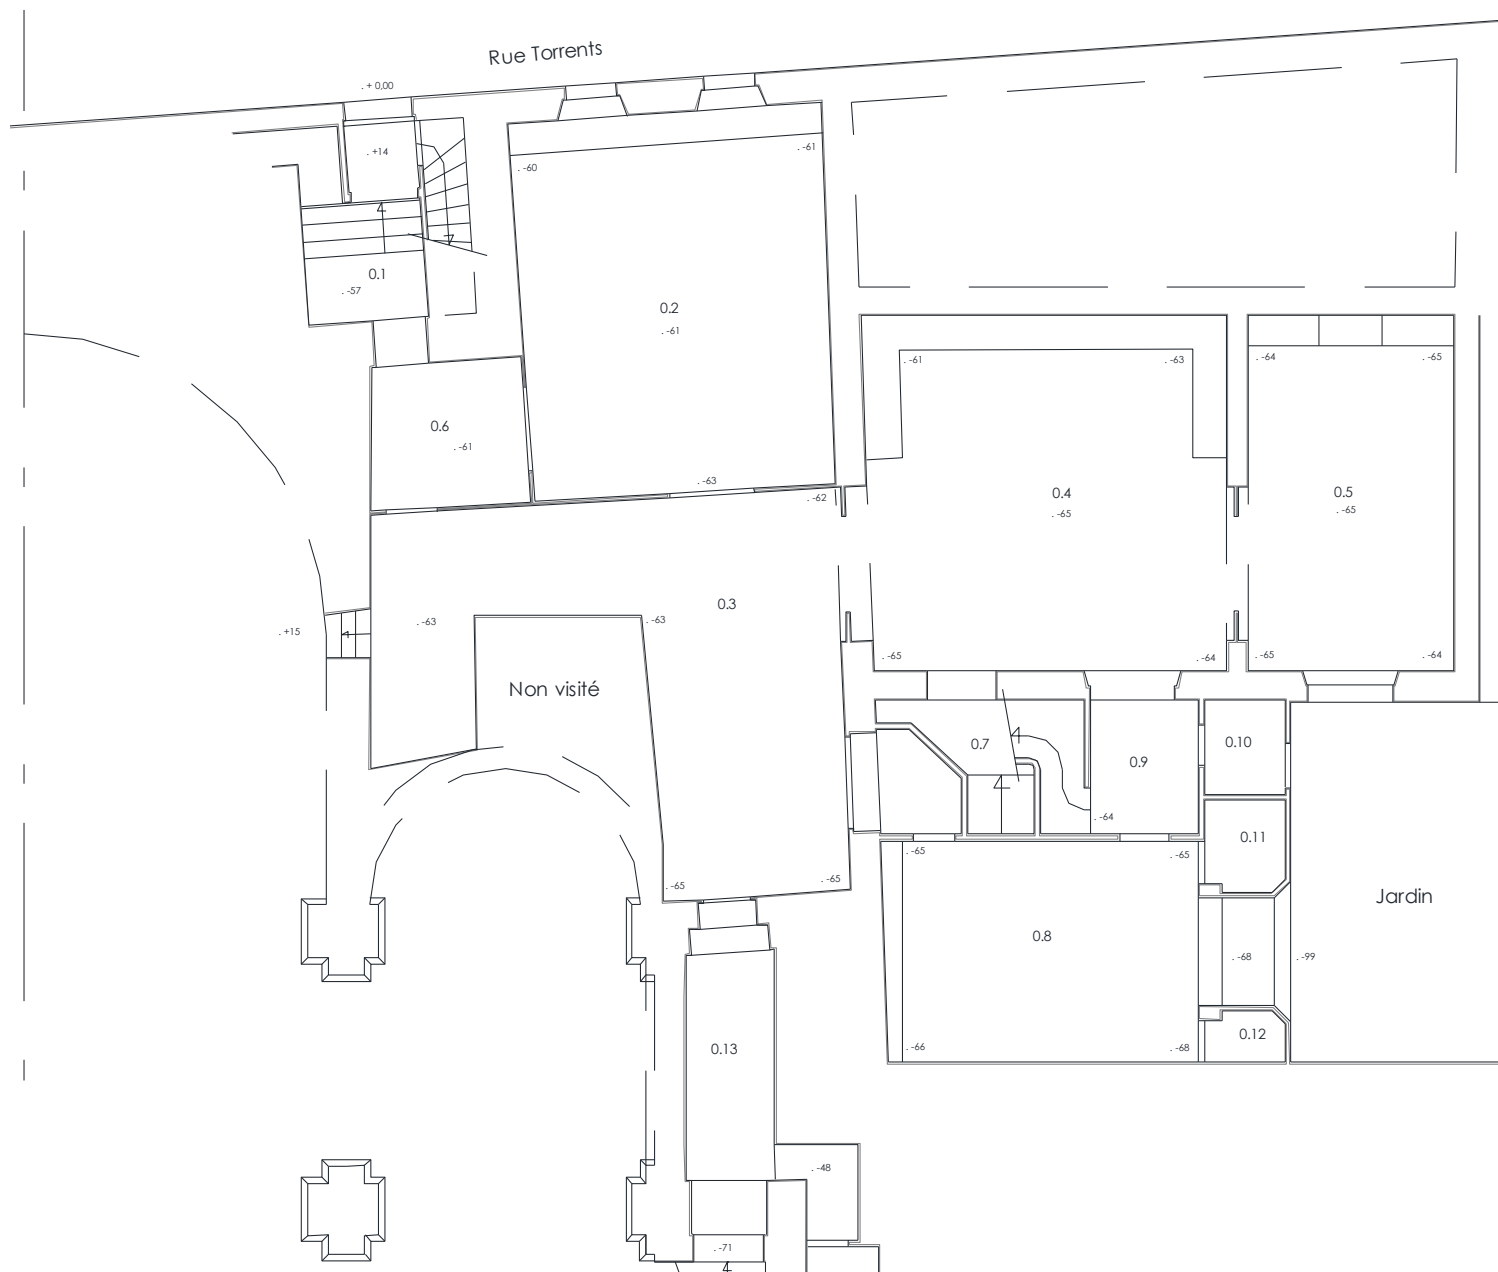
Vue en plan du Rez de Chaussée - Extrait plan Architect-On - Numérotation des salles (0.1 à 0.13)
